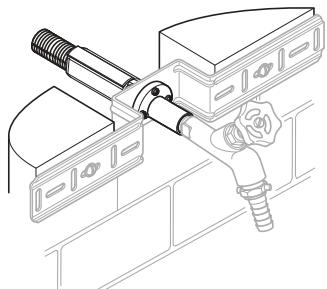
Прямой соединительный элемент с наружным вентилем
